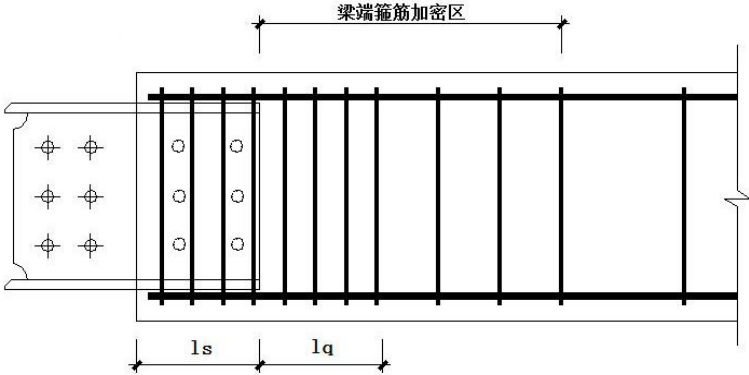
预制钢筋混凝土梁端部构造示意图
